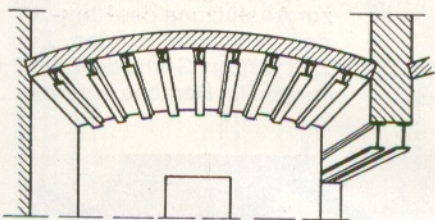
Abstützung einer gewölbten Kellerdecke mit Stahlträgern.
